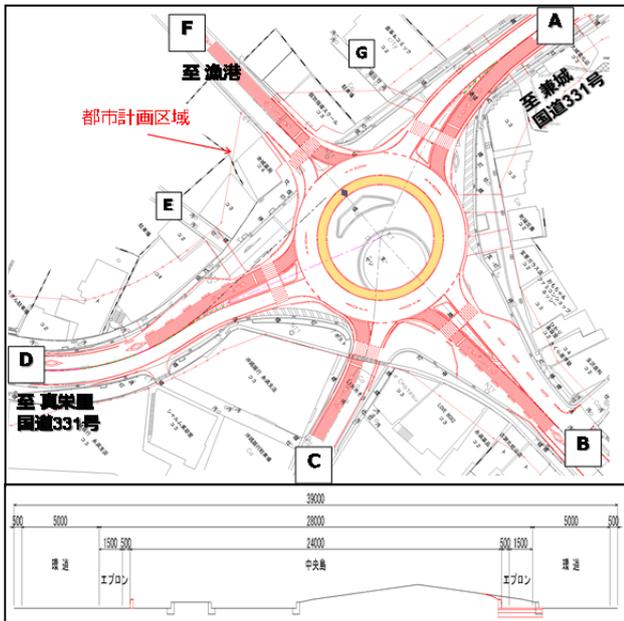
ラウンドアバウト社会実験の計画平面図・横断面図
